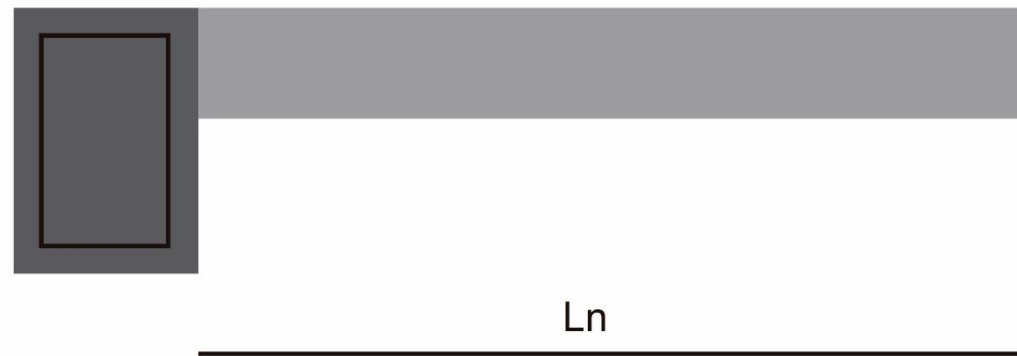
Cálculo estructural muro de corte 10 pisos + 1 subsuelo.
